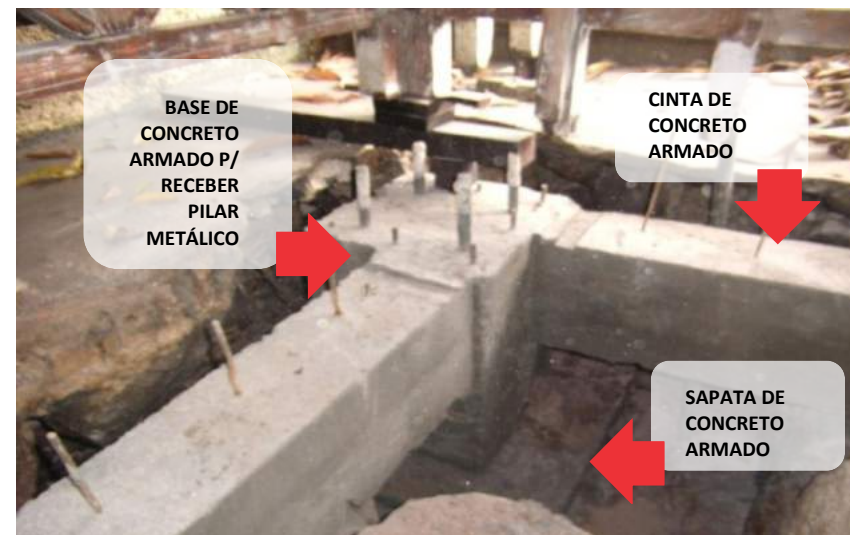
Fundação já pronta, onde é possível ver os conectores da laje de piso e os parafusos de ancoragem dos pilares metálicos. Fonte: Arquivo DPH, 2010
